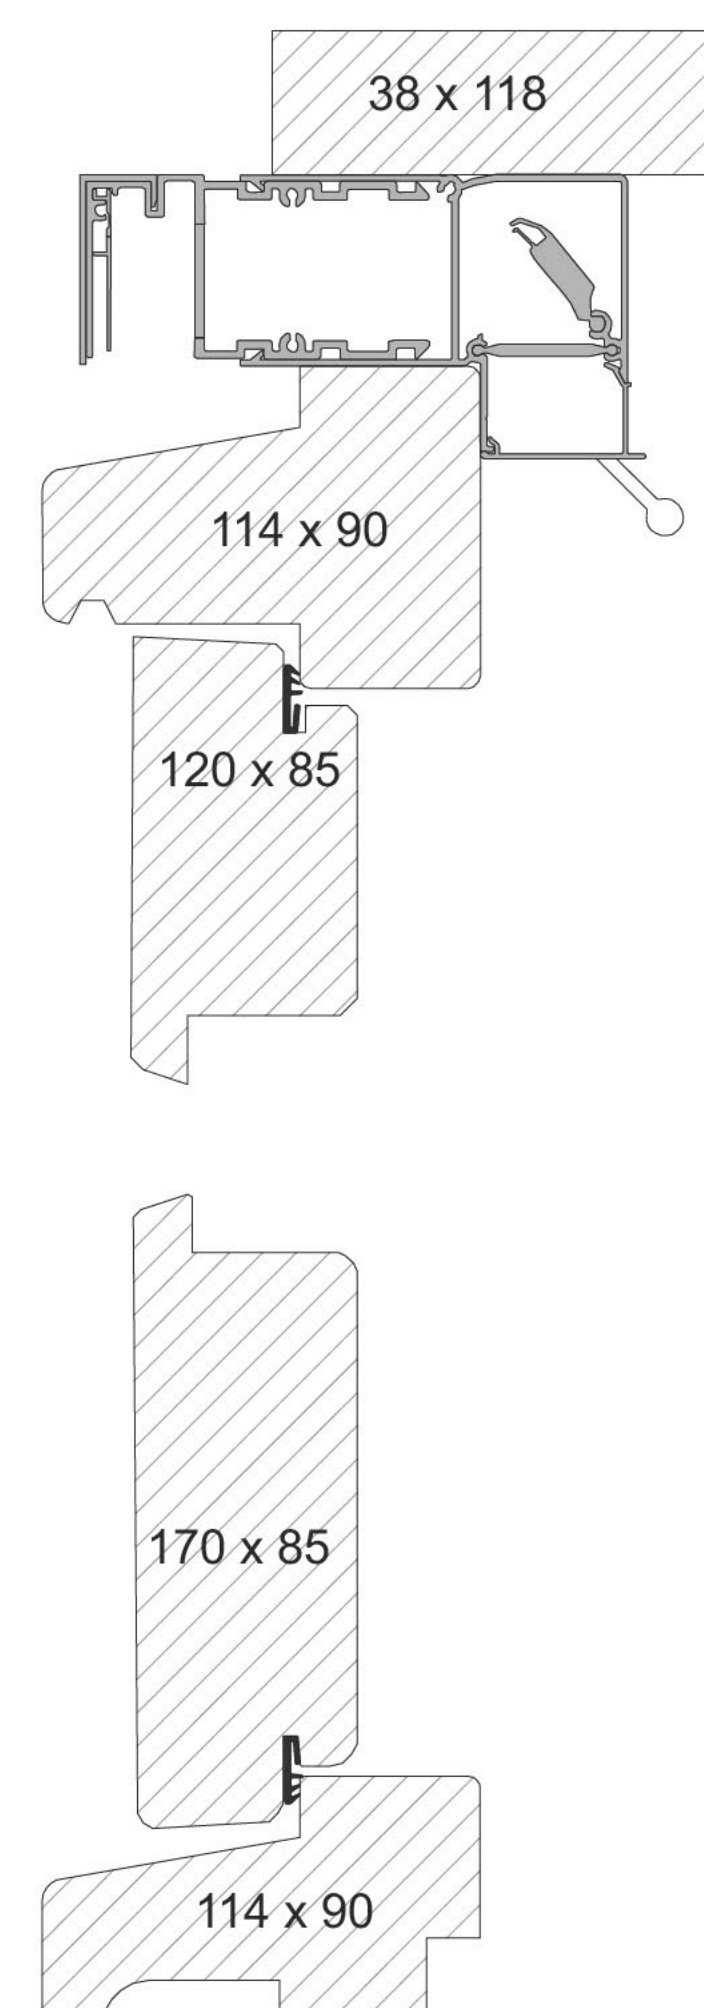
principe detail kozijn, aansluiting openstaande ramen, onder en bovendorpel v.v. Ducotop ventilatierooster - nieuwe toestand
